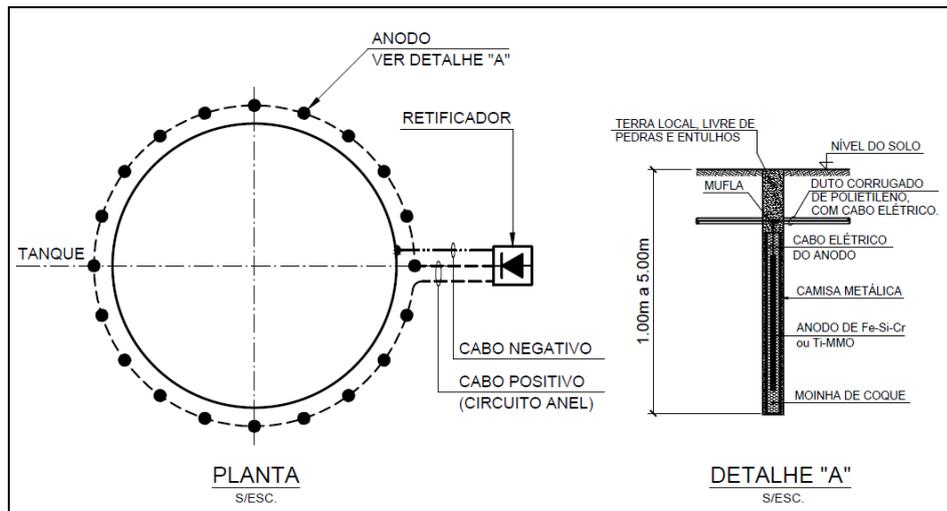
Desenho esquemático de instalação de anodos ao redor do tanque
